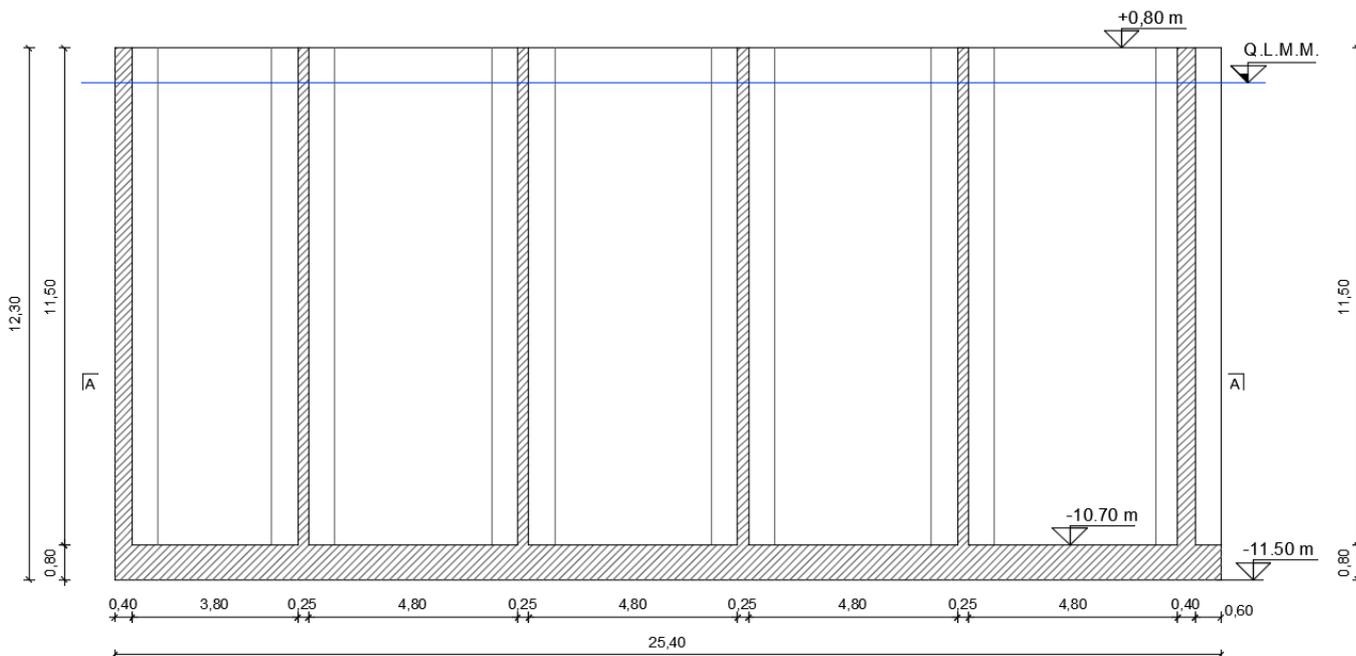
Cassoni tipo 2 (trapezio): Carpenteria - Sezione verticale longitudinale C-C
